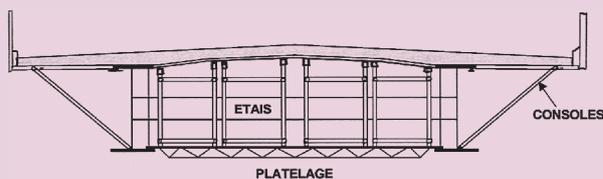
Coffrage traditionnel de la dalle d'un bipoutre à entretoises
